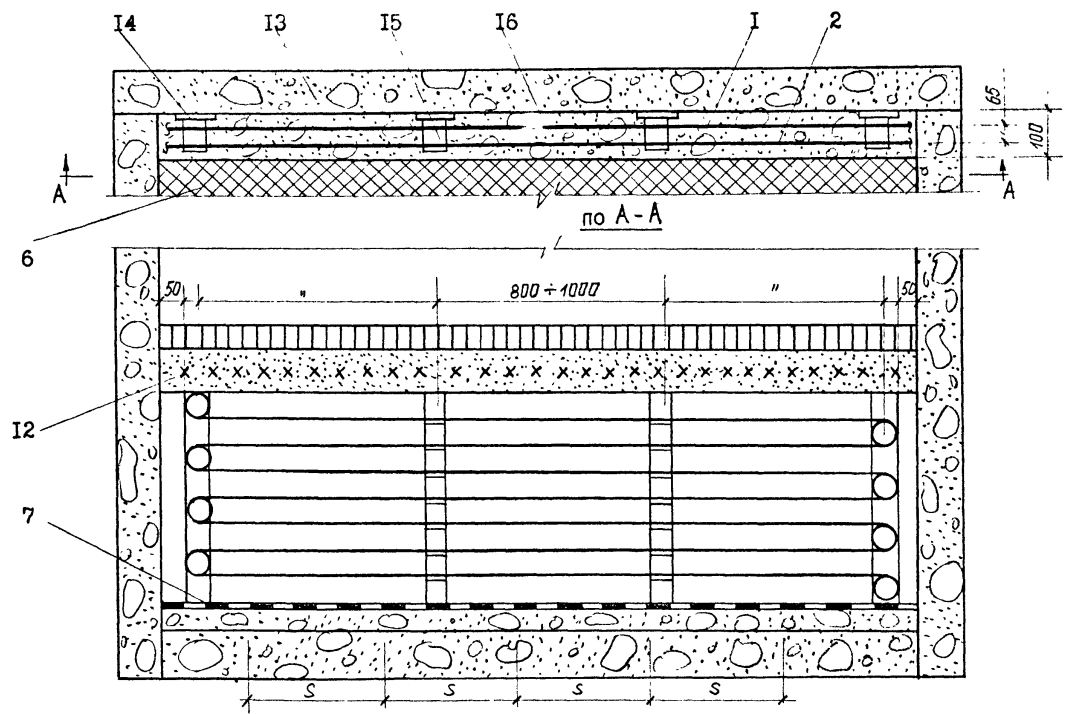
Схема кабельного обогрева стены 1,2,6,7,12 - см.рис.7.10а; 13-стена; 14-стойка опорная конечная; 15-стойка опорная промежуточная; 16-замоноличивающий слой стены
